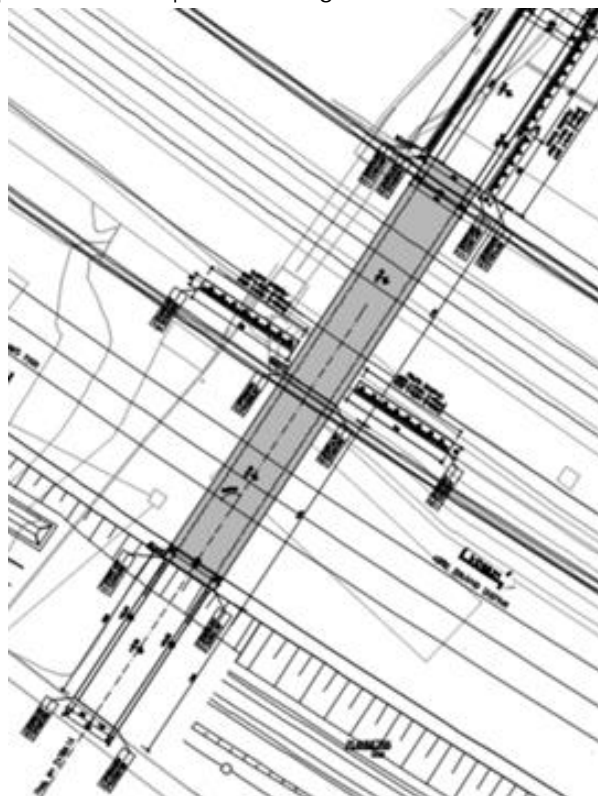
Stralcio planimetrico – Ubicazione Sottovia IN04
